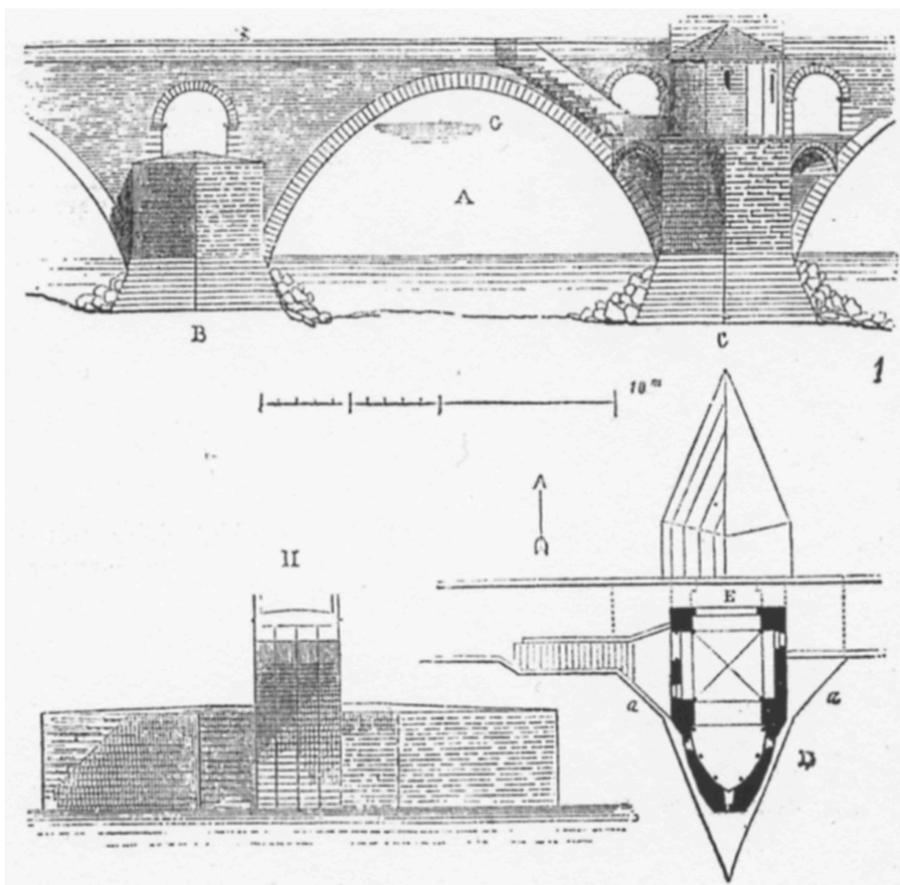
Géométral de M. Viollet-le-Duc et plan inférieur de la chapelle
